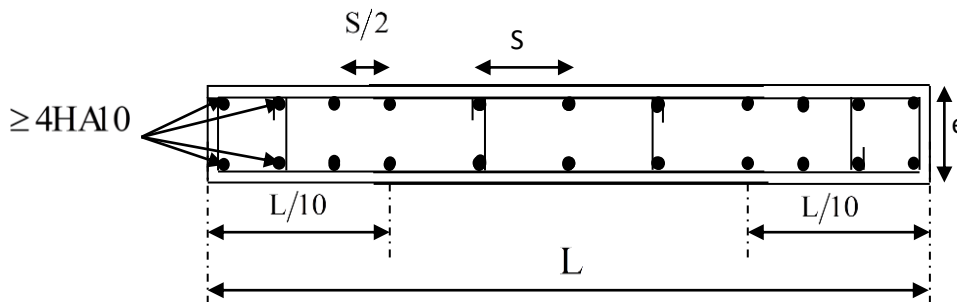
Disposition des armatures verticales dans les voiles.
